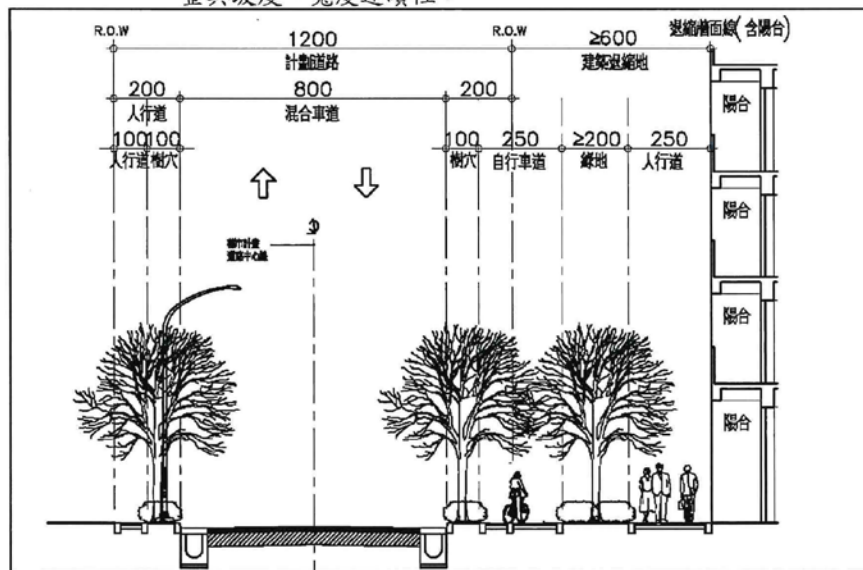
建築基地臨道路退縮空間配置示意圖（一）
